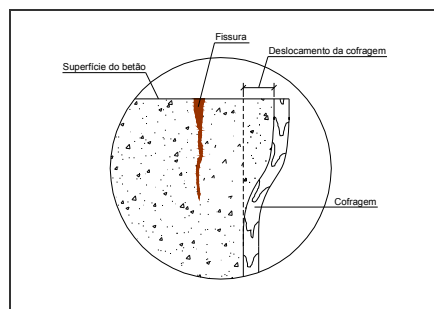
Fissura por deslocamento da cofragem.
